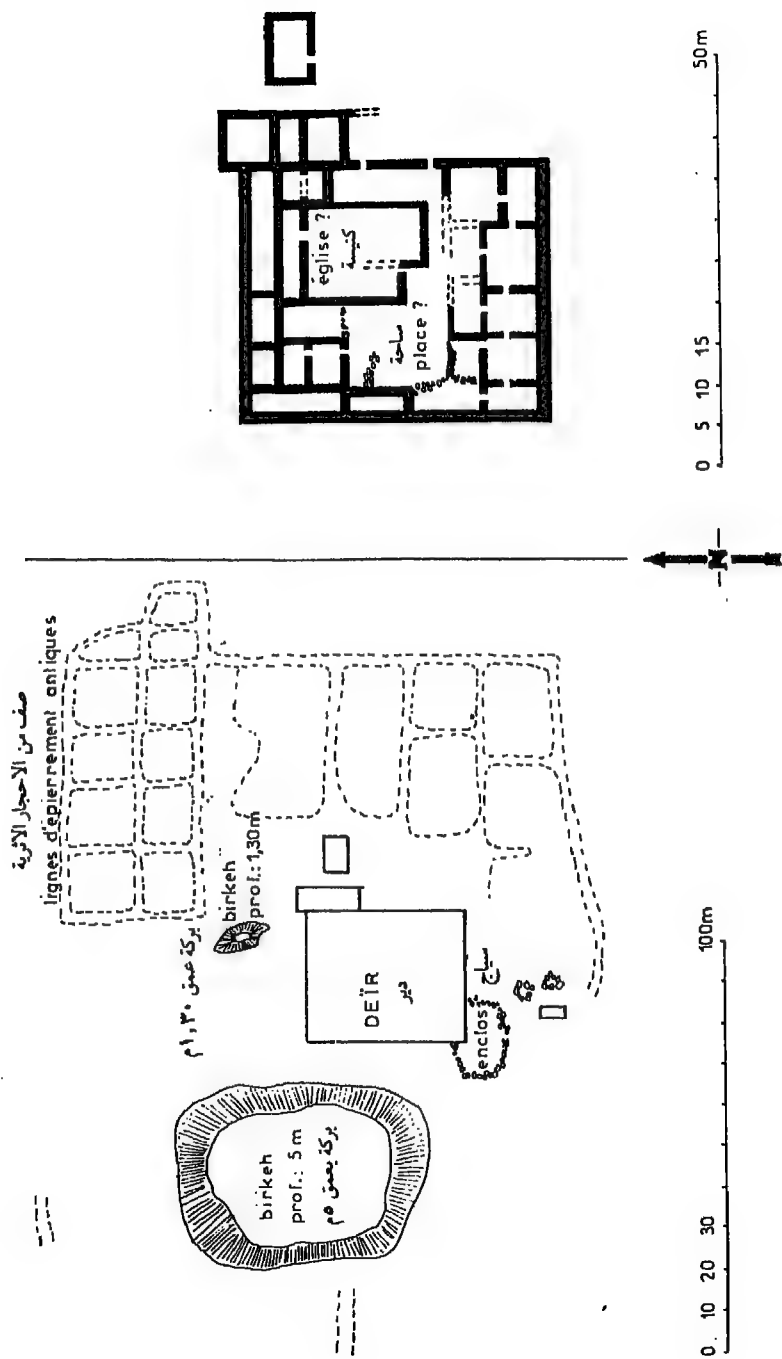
Deir ash-Sha'ir : plan de situation et plan du déir.
